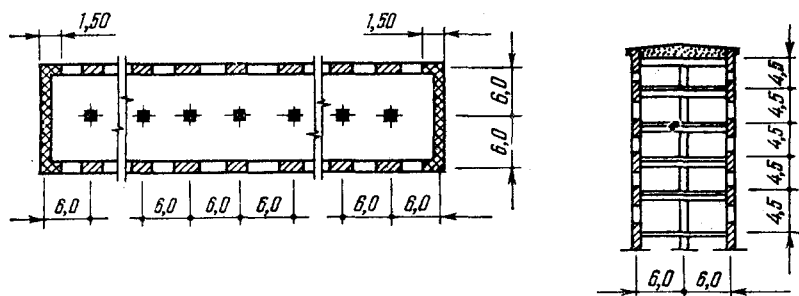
План и разрез пятиэтажного кирпичного здания.
